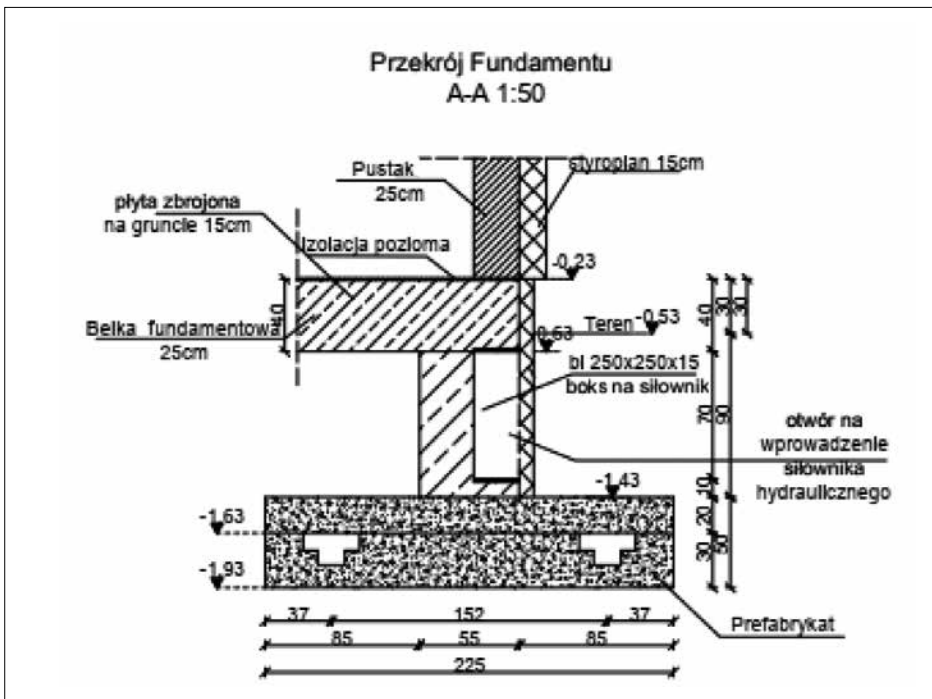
Konstrukcja fundamentu budynku przy posadowieniu pośrednim na palach lub studniach
